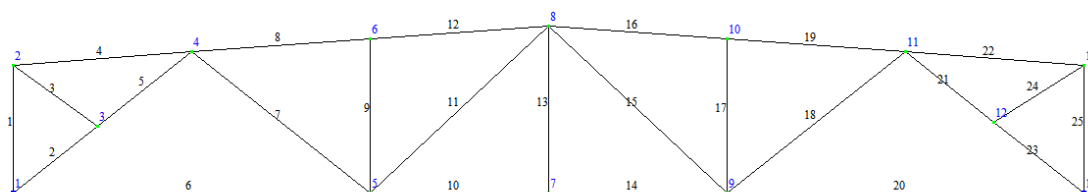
Конечно-элементная модель стропильной фермы Ф-1
